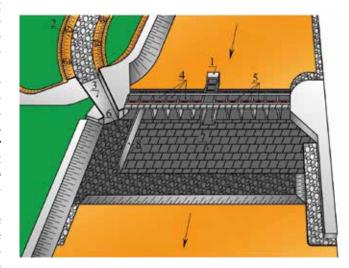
План-схема Багаевского гидроузла на реке Дон
